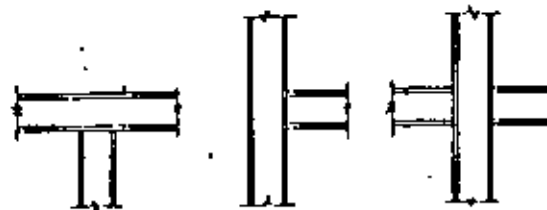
CONEXIONES VIGA-COLUMNA
